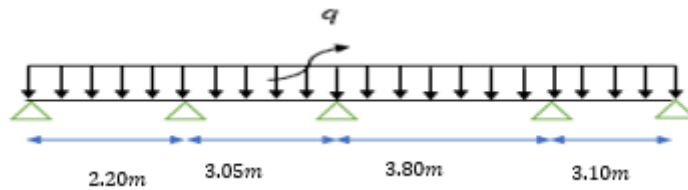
Schéma statique de la poutrelle appuyée sur 5 appuis.
